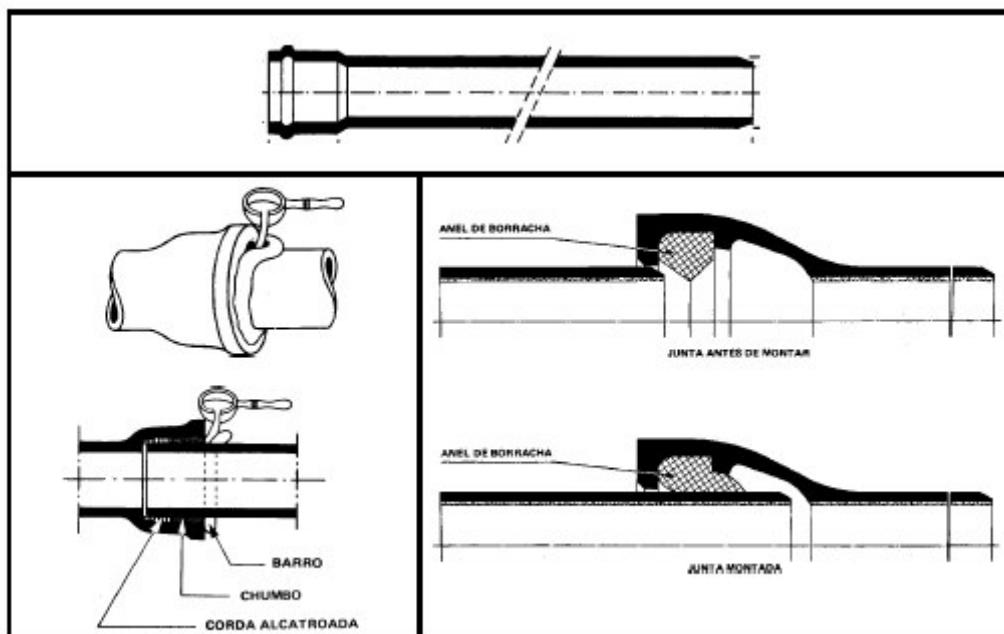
LIGAÇÕES DE PONTA E BOLSA
